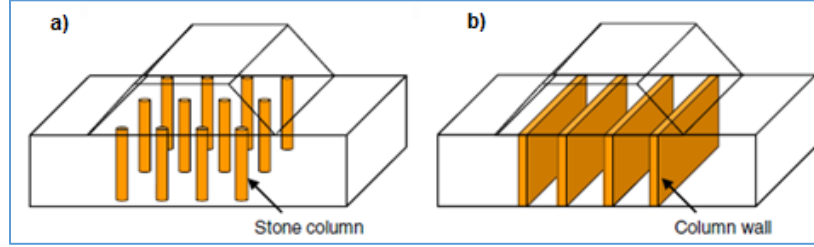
Vista de terraplén apoyado suelo blando mejorado: a) Columnas individuales; b) Columnas de muro.
